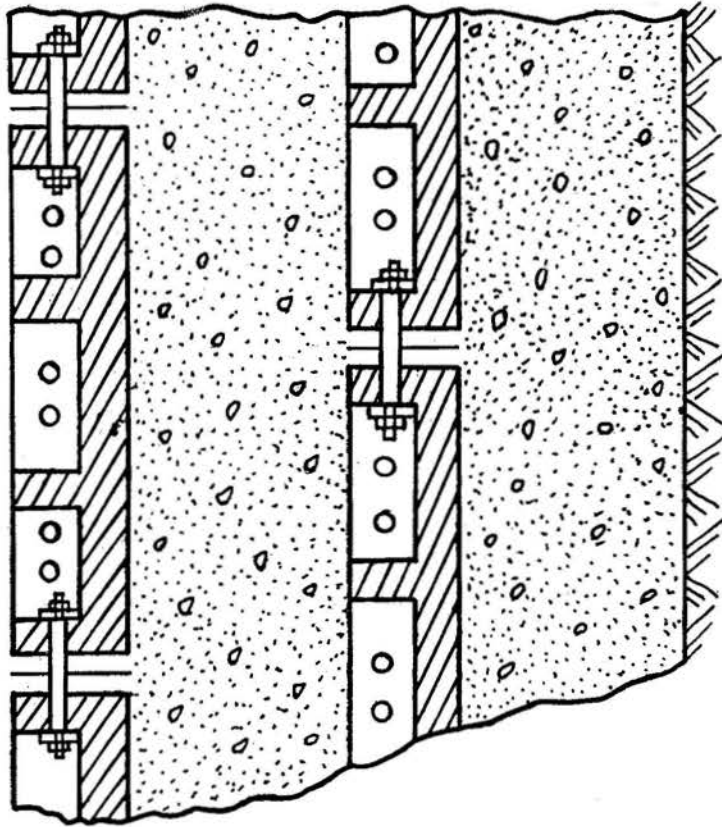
Fortificación de doble estructura de blindas metálica y hormigón.
